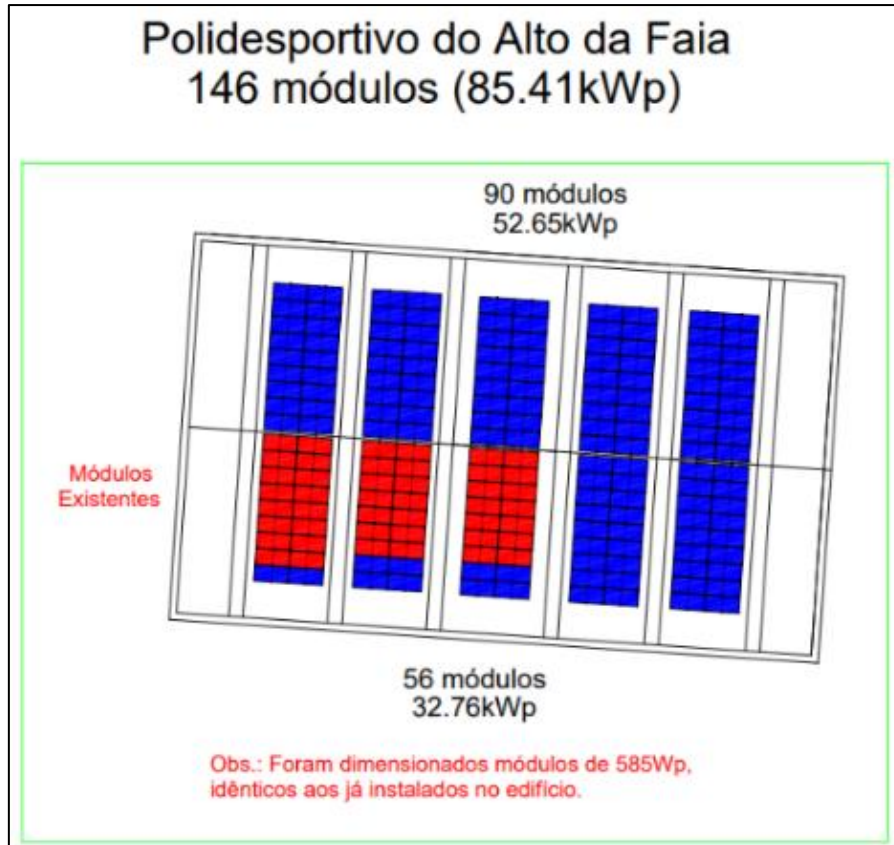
Esboço do local de instalação dos painéis - Pavilhão do Alto da Faia.
